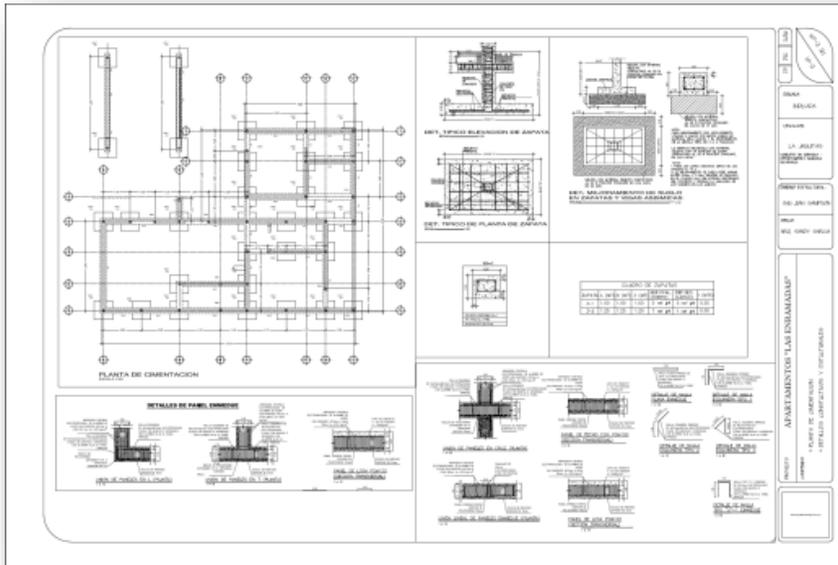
Ejemplo de plano estructural de cimentación. Recuperado de: S. García (2016)
